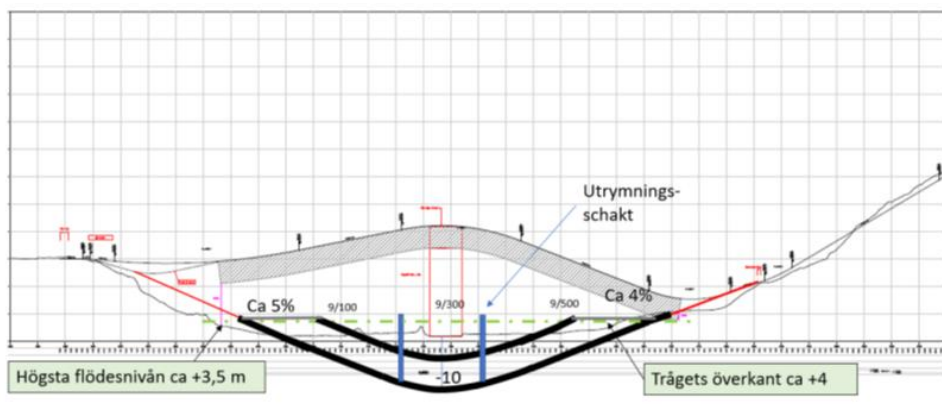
Placering av tunnel, tråg och utrymnings-schakt för alternativ TUA.
